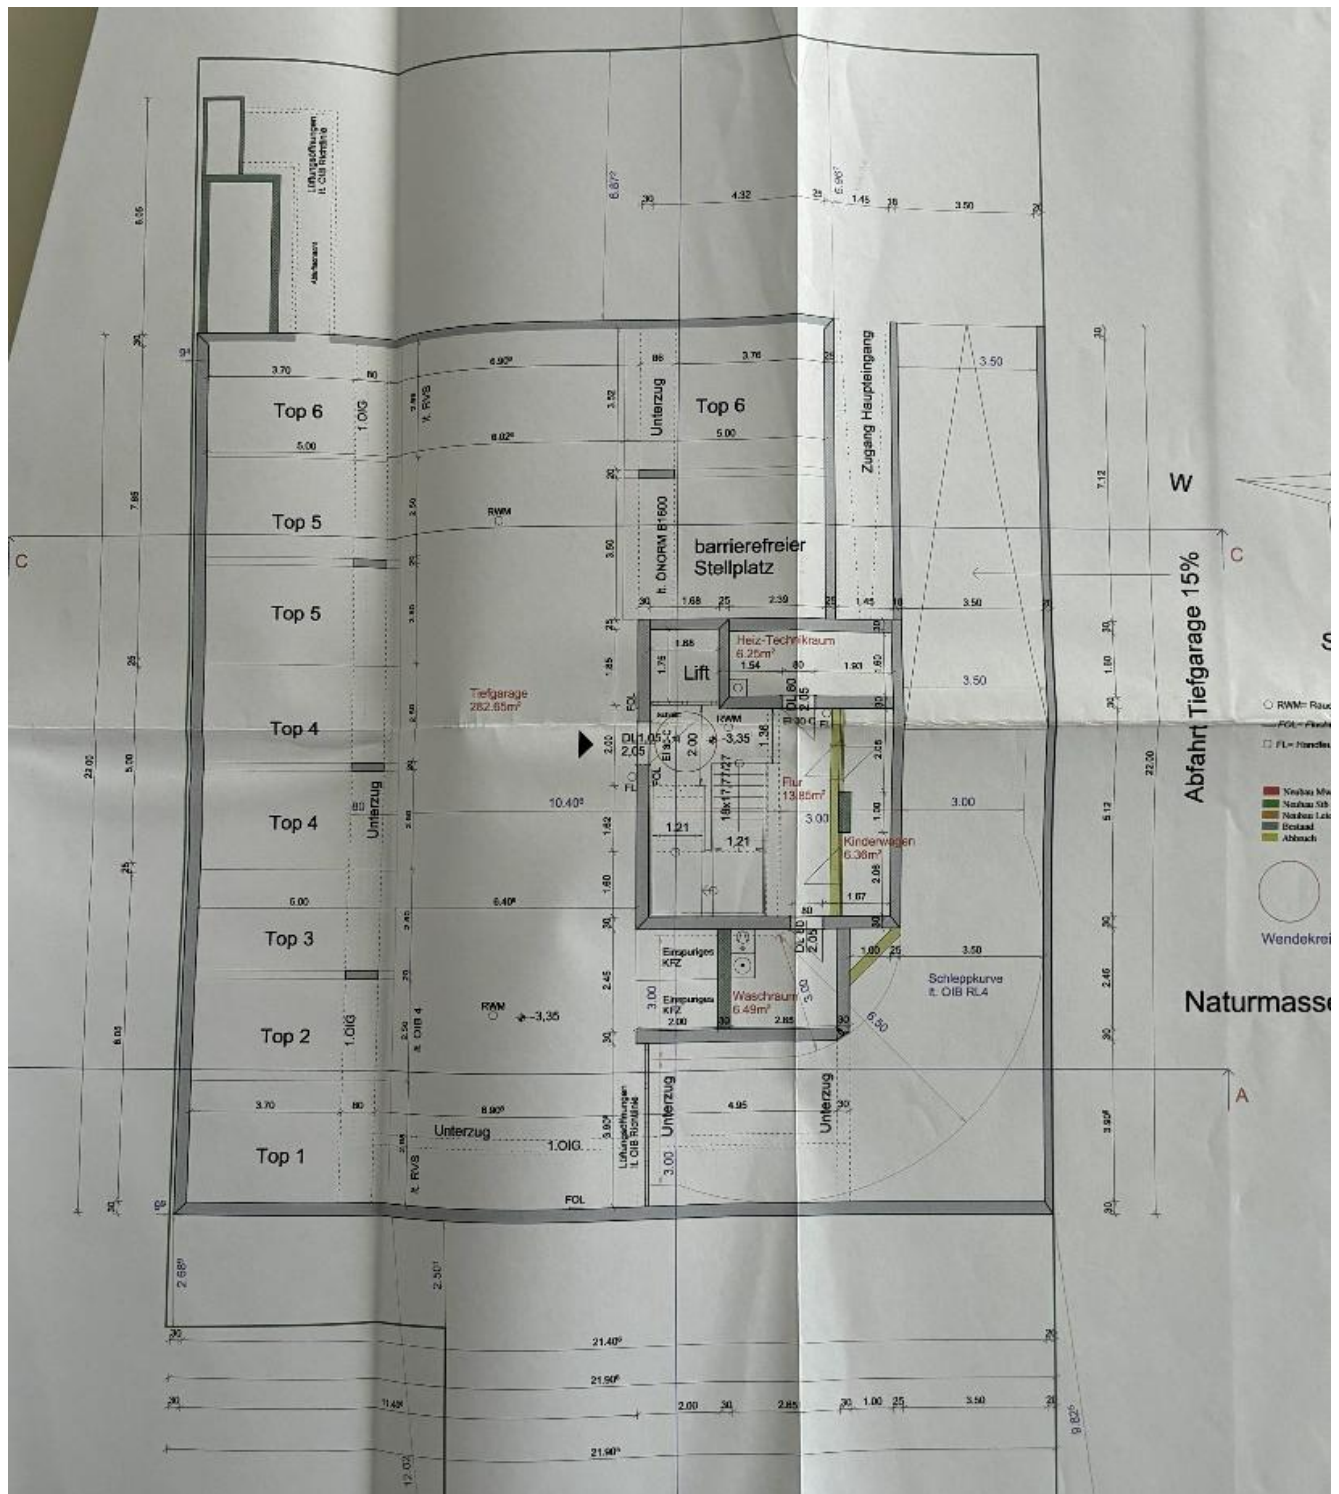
Grundriss UG / Tiefgarage
